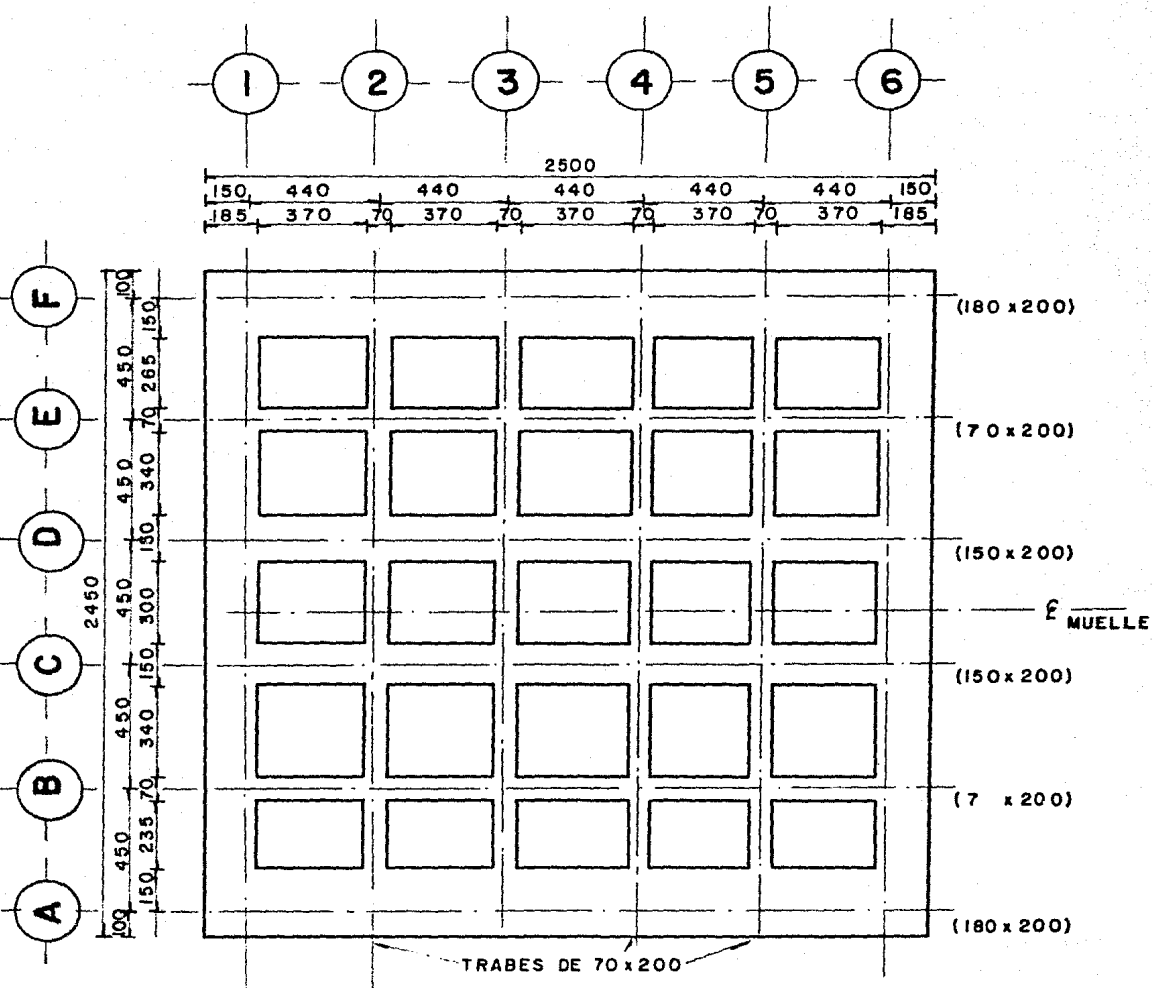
PLANTA TIPO DE PILOTES EN PLATAFORMA DE OPERACION
